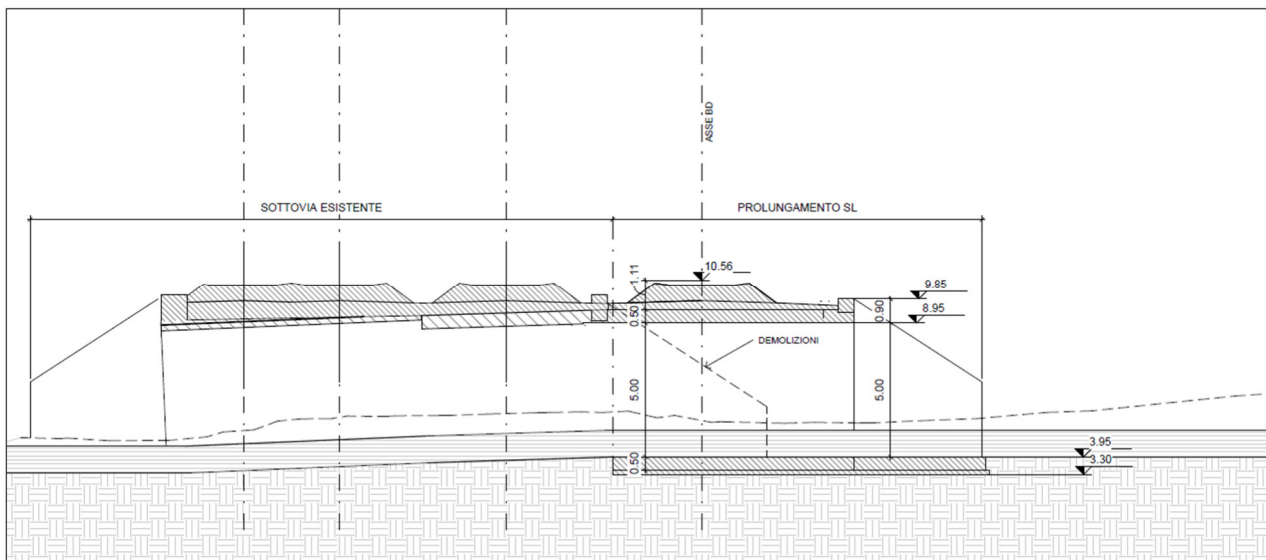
Planimetria d'inquadramento sottovia SL05
